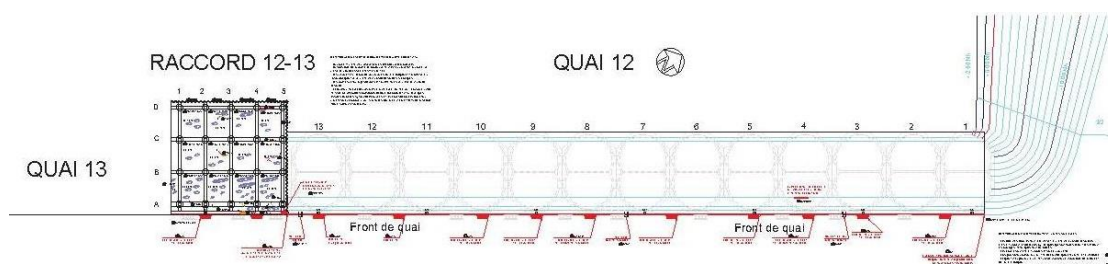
Plan du quai 12 dans sa configuration actuelle
